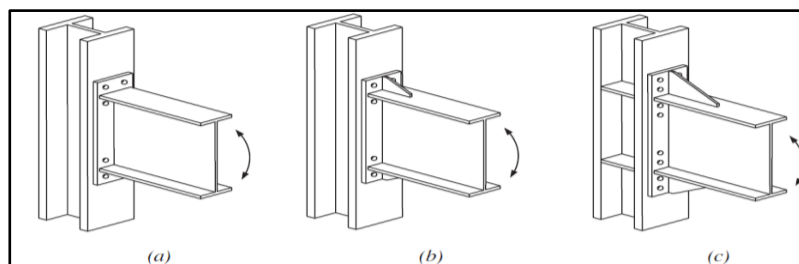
Modelo de conexión con placa al extremo; a) BUEEP con 4 pernos no reforzados; b) BSEEP con 4 pernos reforzados y; c) BSEEP, con 8 pernos reforzados. AISC341 (2016)
